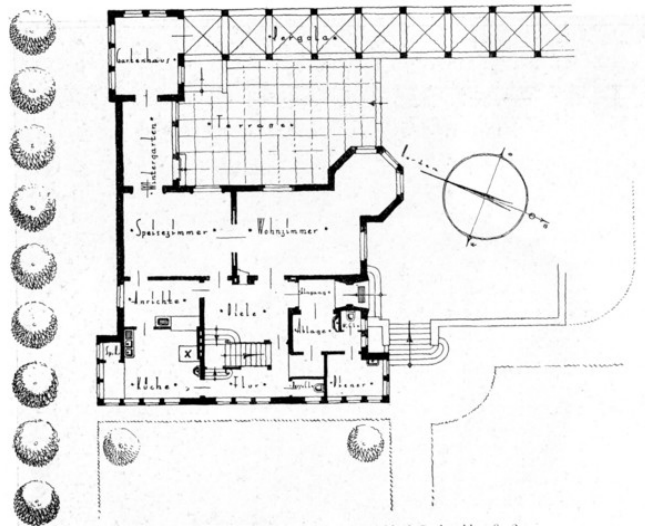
Grundriss des Wohnhauses für Dr. F. Sack, Düsseldorf – Arch.: Walter Furthmann
